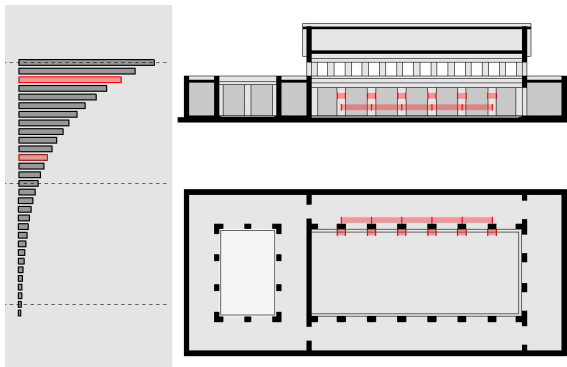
Planta e corte longitudinal da igreja, com as medidas do Número Plástico
